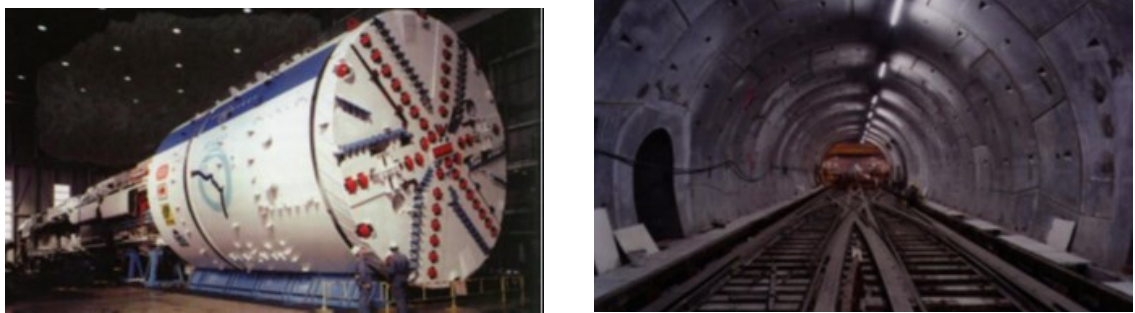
Construction par tunnelier (à gauche) et revêtement en voussoirs (à droite) de la ligne 14 de Métro (Douroux, 2012)
